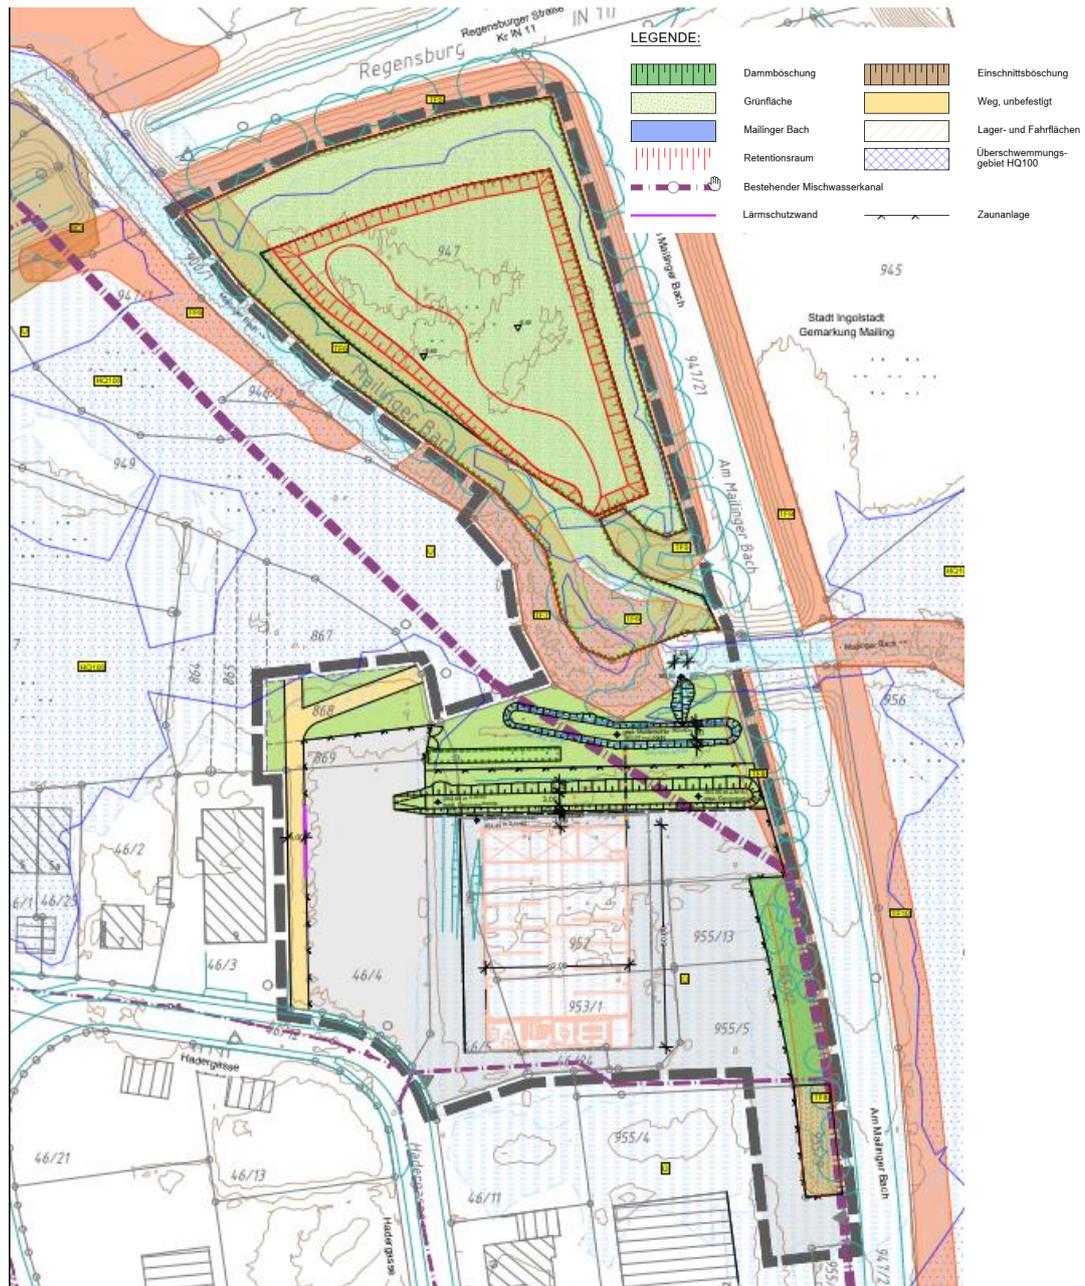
Plan Entwurfgenehmigung Bbauungs- und Grünordnungsplan (Quelle: WipflerPLAN [5], ohne Maßstab)
